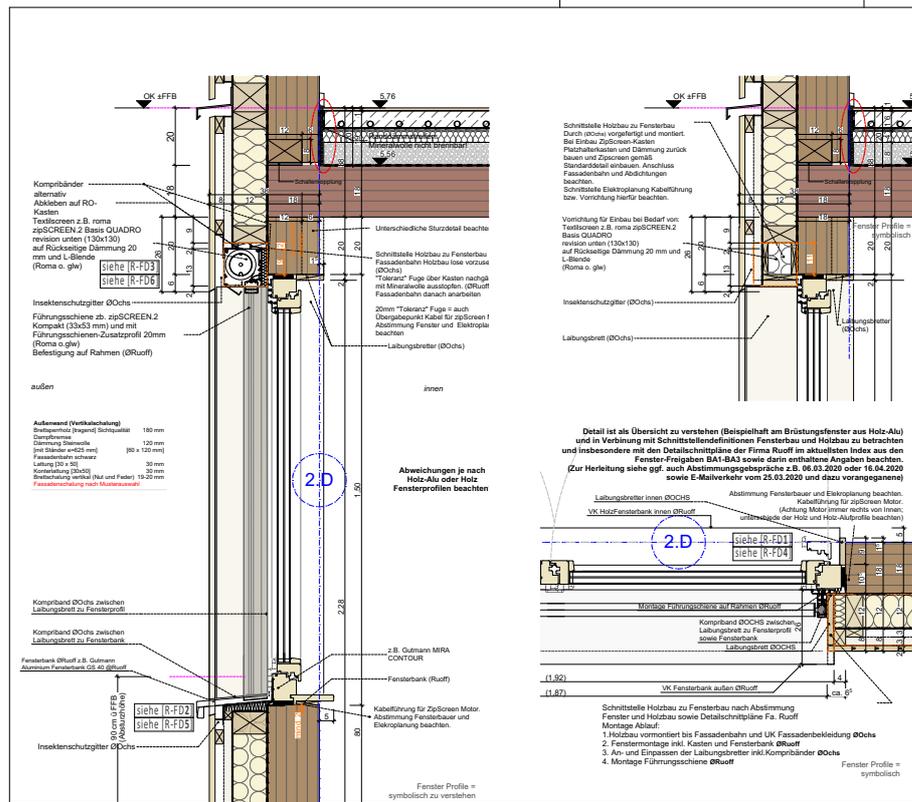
Plan 221-05-022-1 Fenster BRH 80 Außenwand
